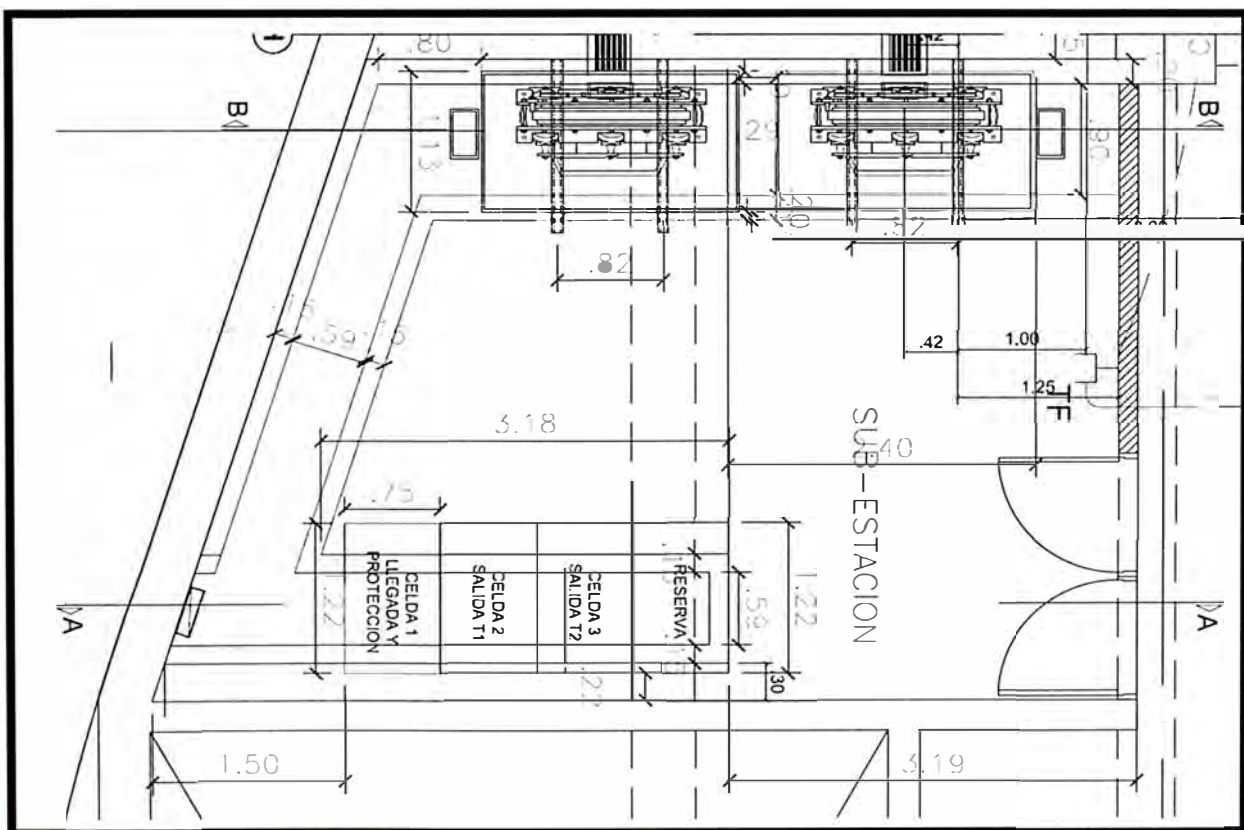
(Plano de planta de Cuarto Eléctrico SE No 1)
